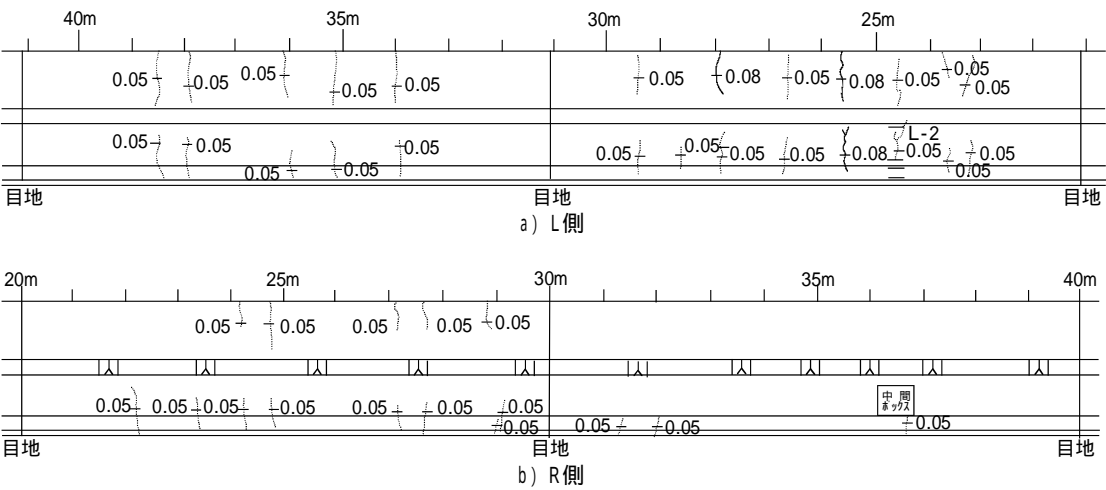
末広第 2 工区のひび割れ状況図 (展開図)
